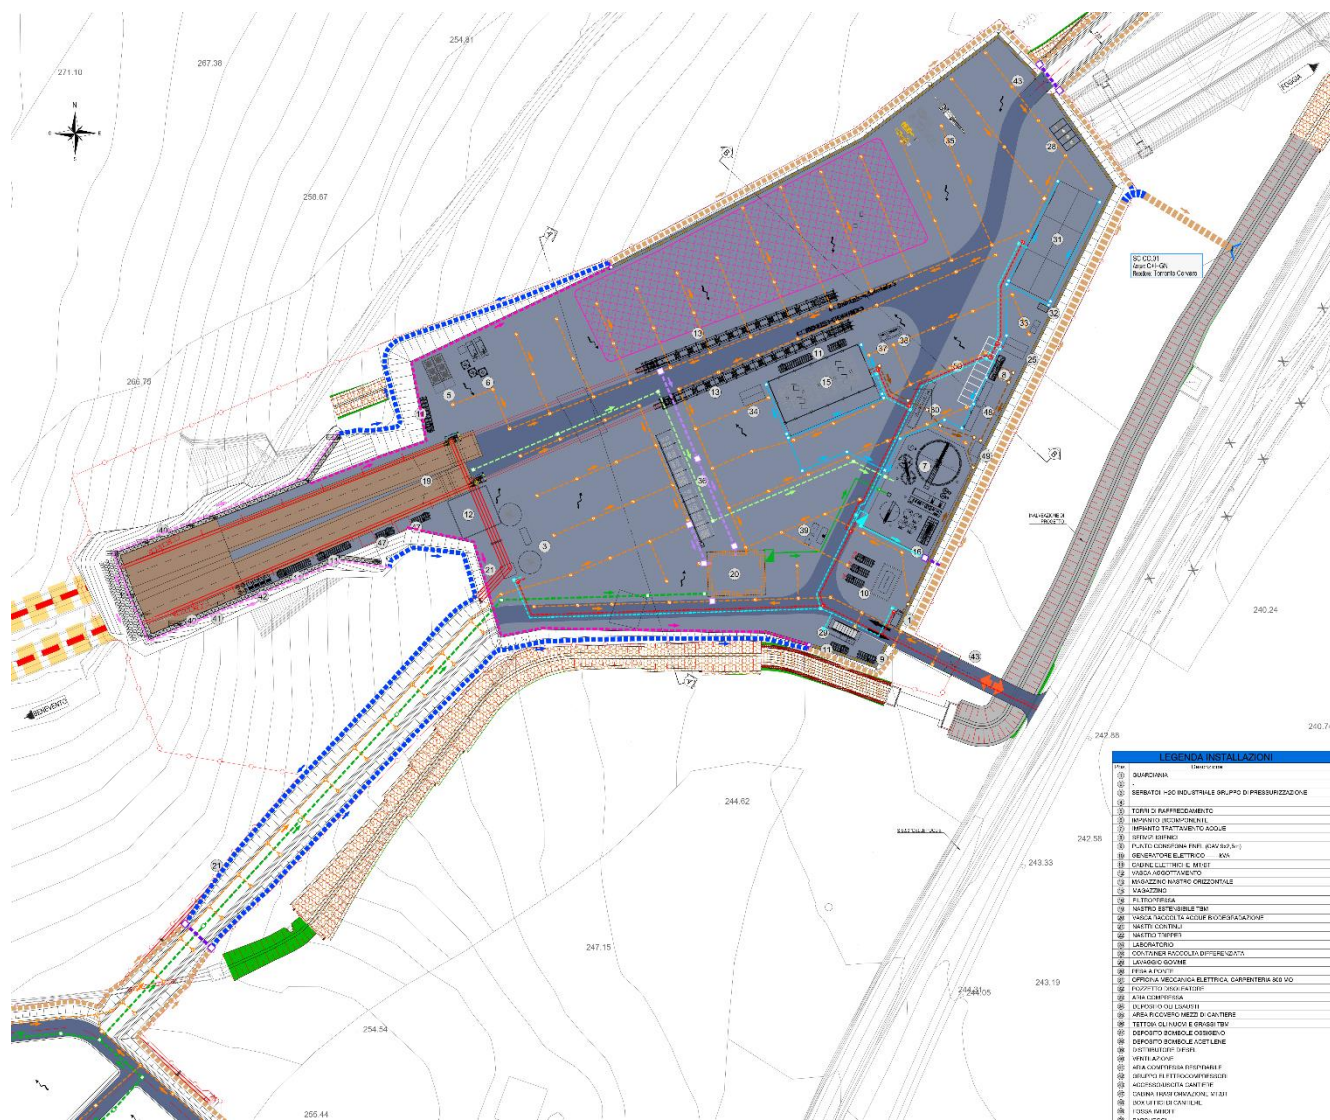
Planimetria complessiva del cantiere GI01- CO.01
